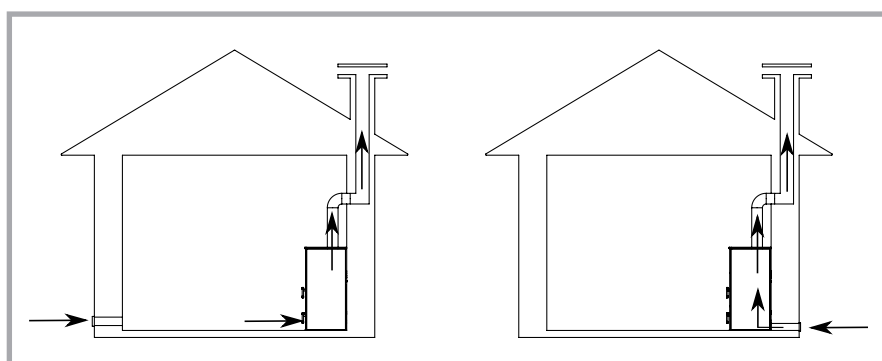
Installazione mediante presa d'aria nel locale e installazione con presa d'aria esterna collegata direttamente alla termostufa a legna.
